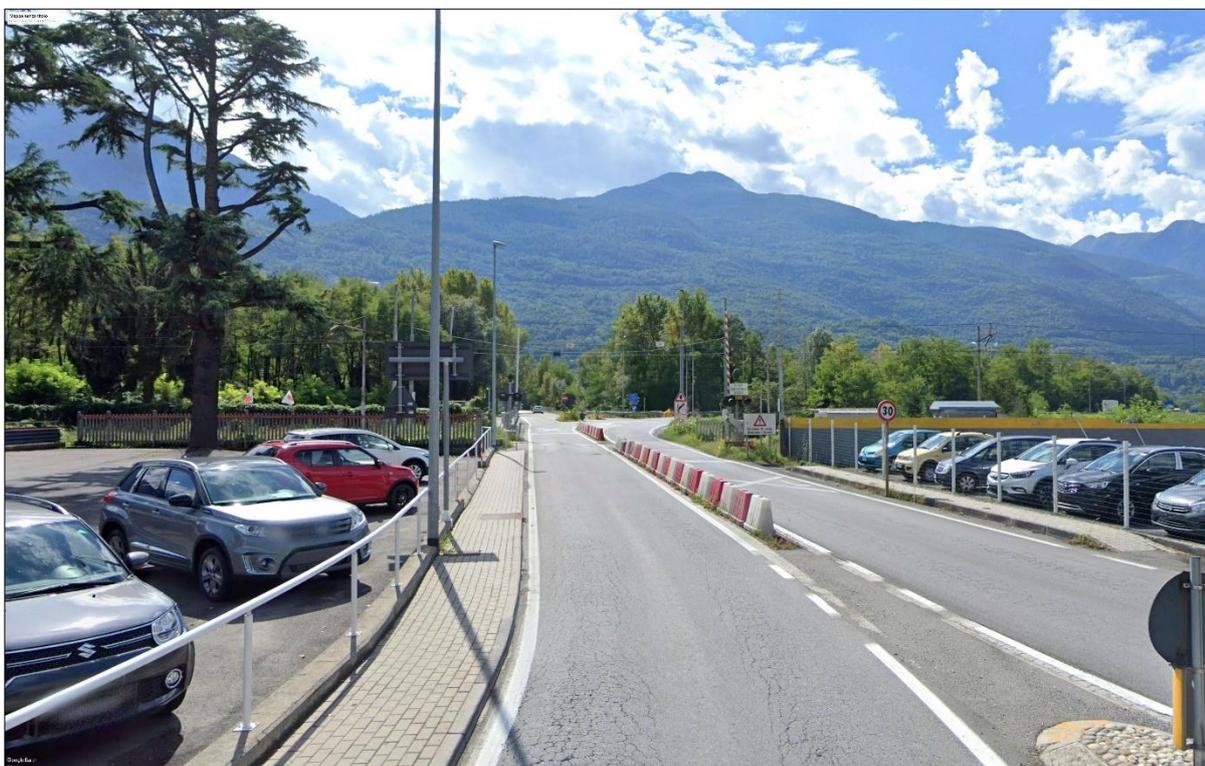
nuovo viadotto visto dalla rotondina sullaSS38
